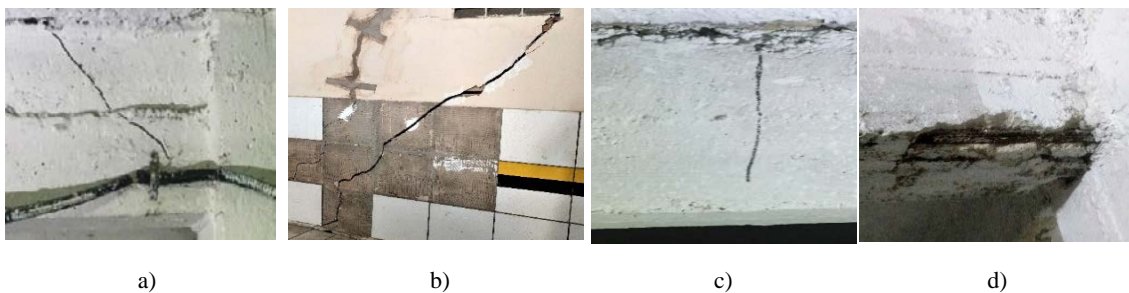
Manifestações patológicas no edifício em estudo. a) Fissuras de cisalhamento; b) Rachadura em alvenaria; c) Fissuras de flexão; d) Exposição e corrosão de armadura.
